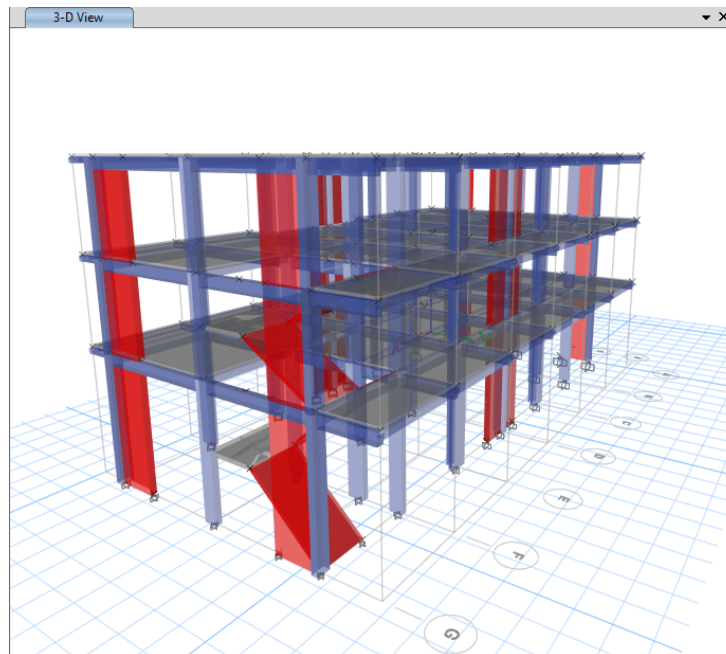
Definición elementos Wall (muros) e=0.25m.
